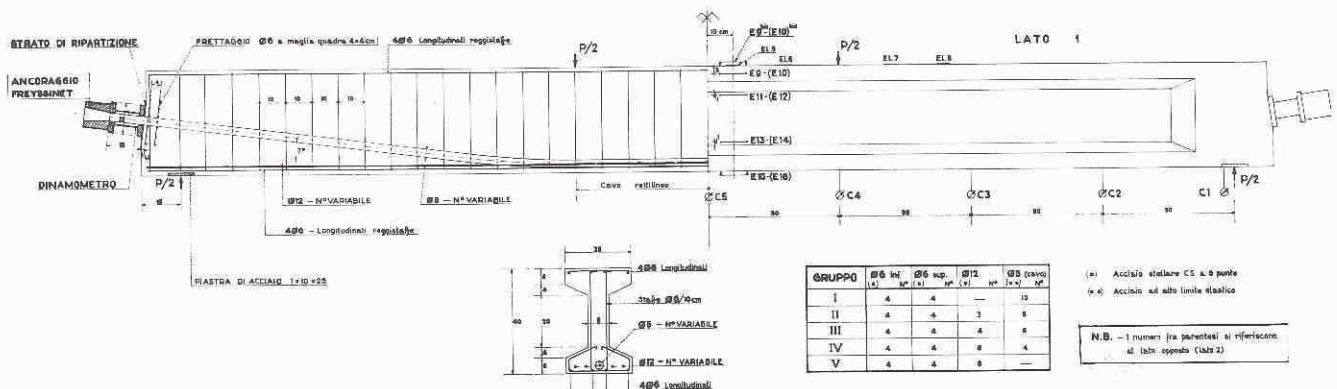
1/2 sezione longitudinale con disposizione armature; 1/2 vista longitudinale con disposizione strumenti.
